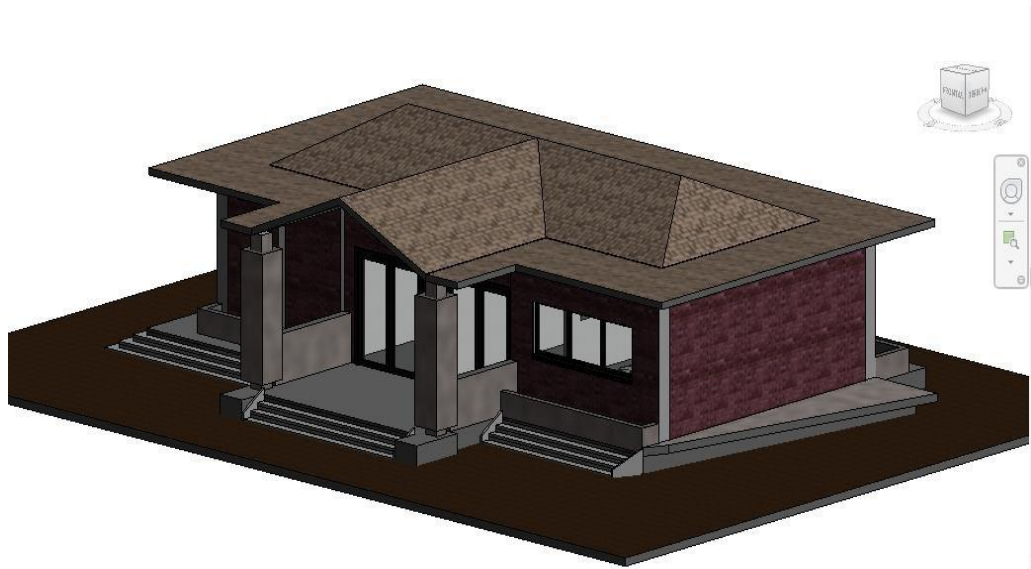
Fachada lateral 1 del levantamiento 3D a través de Autodesk Revit.
